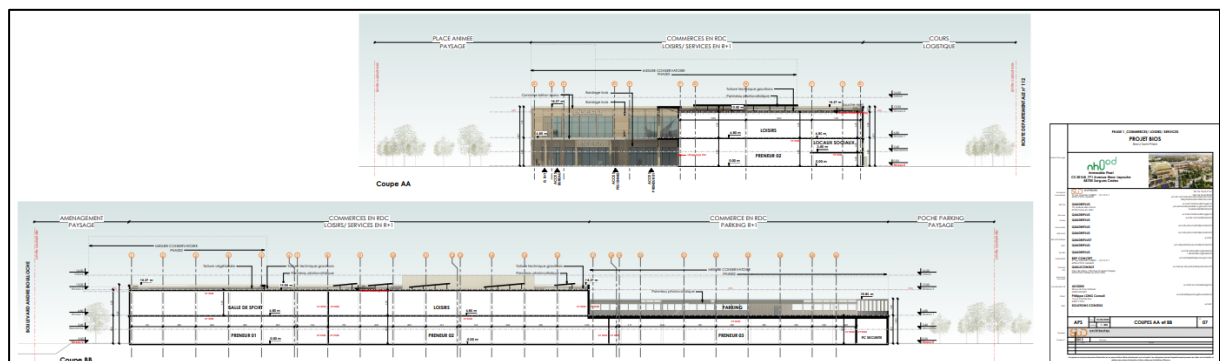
Plan de coupe des infrastructures (Coupe AA et BB) (source : PC 2023)
